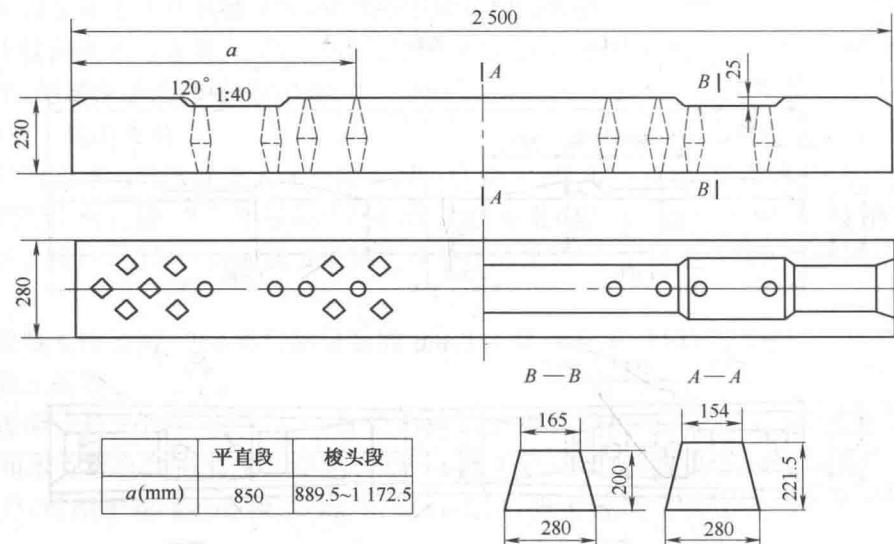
混凝土桥枕外形和截面尺寸(单位:mm)
